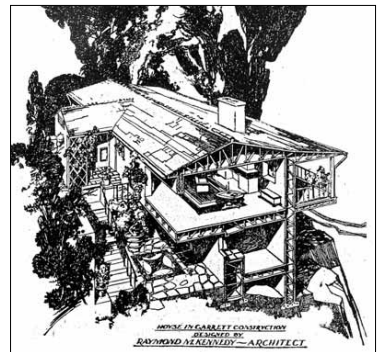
가렛 건설공법 (Garrett construction system)을 이용한 레이몬드 케네디의 디자인(1933년 5월 LA Times의 Sunday Magazine에 실린 가렛 건설공법의 적용에 관한 예)
